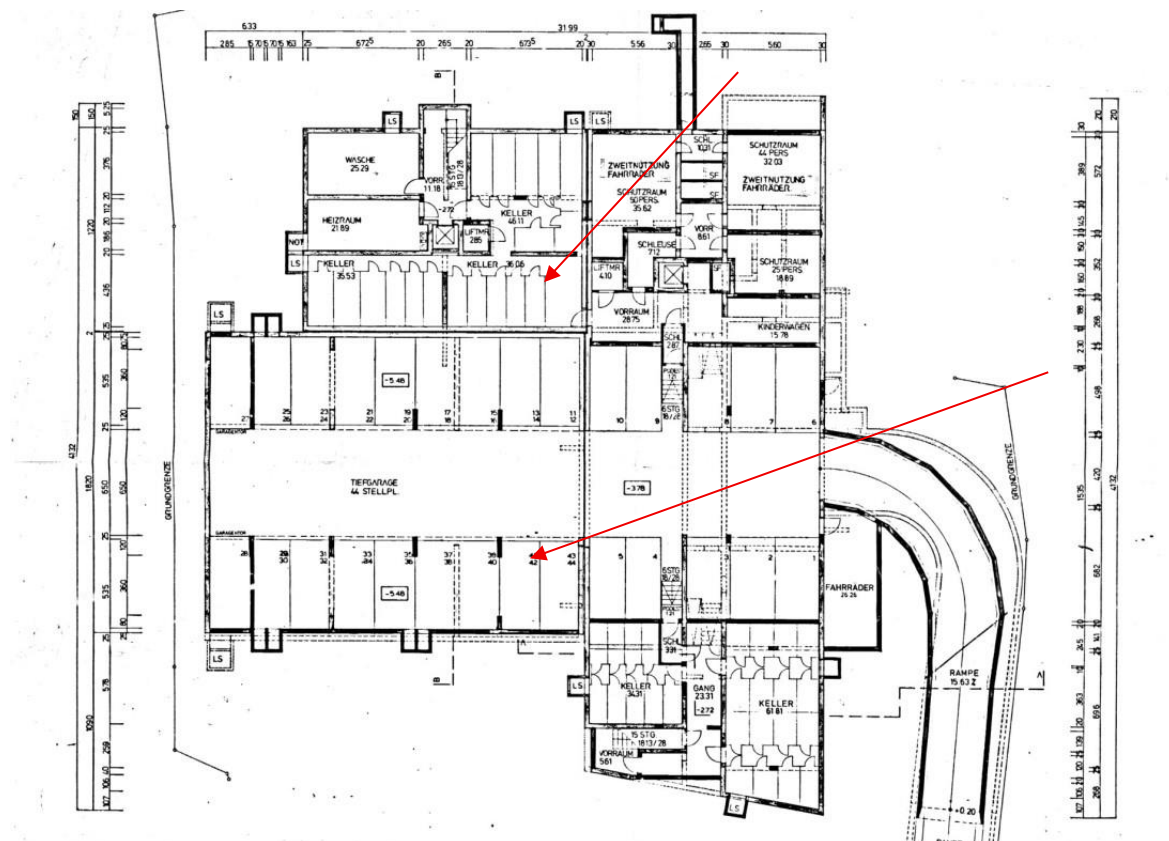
Grundriss Keller u. Tiefgarage
